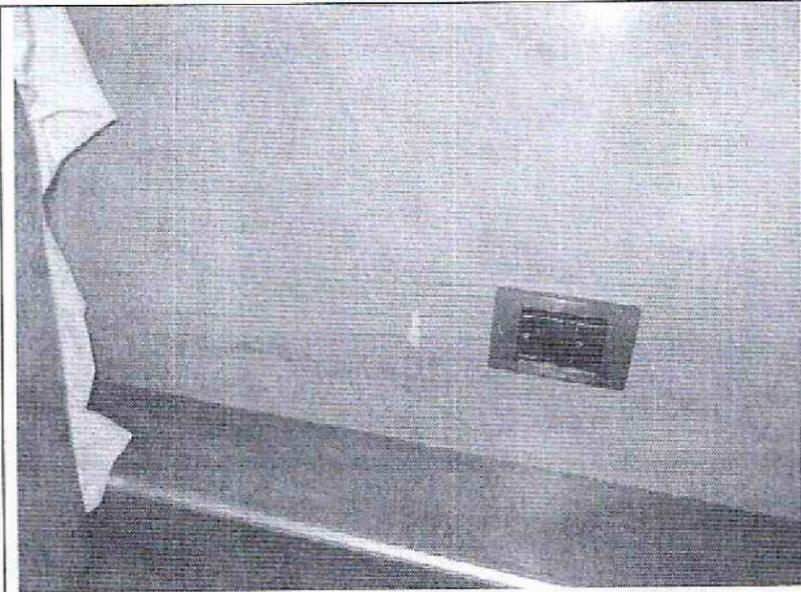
Agrietamiento en muro del tercer piso.
